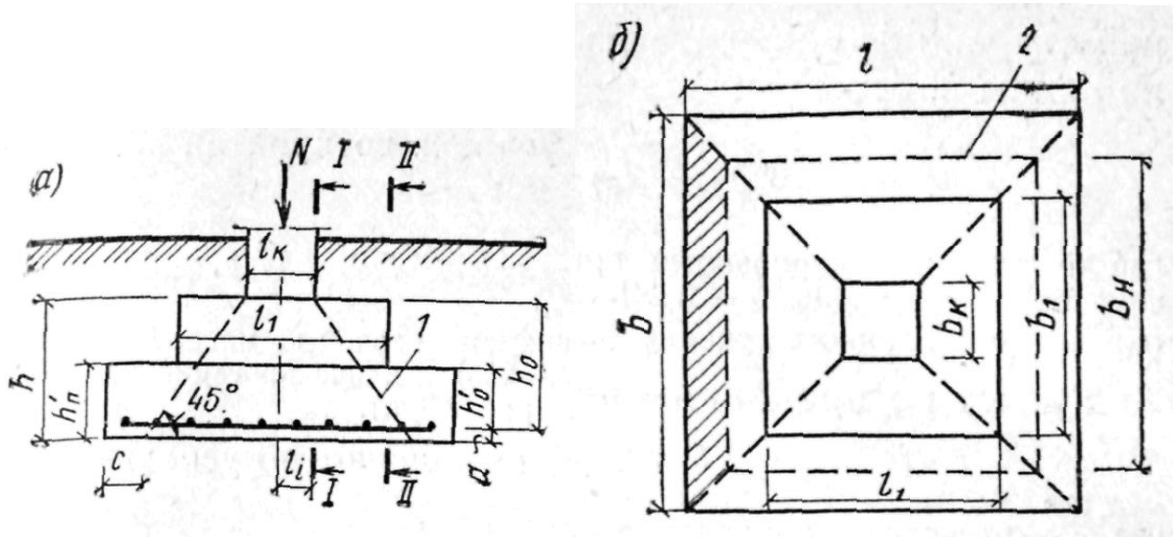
Схема до розрахунку конструкції центрально навантаженого фундаменту:
